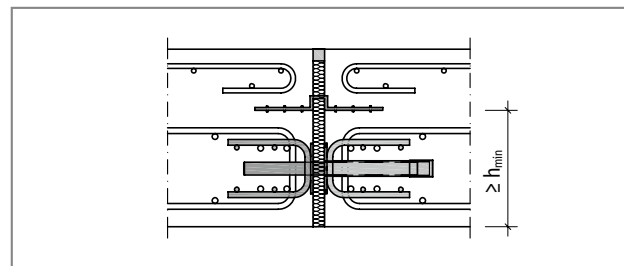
Schöck Dorn Typ SLD: Dehnfuge mit Fugenband
